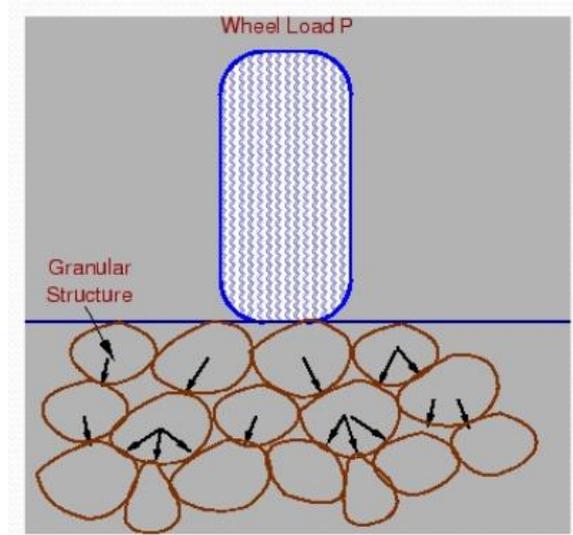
Transferencia de Cargas a un Pav. Flexible
